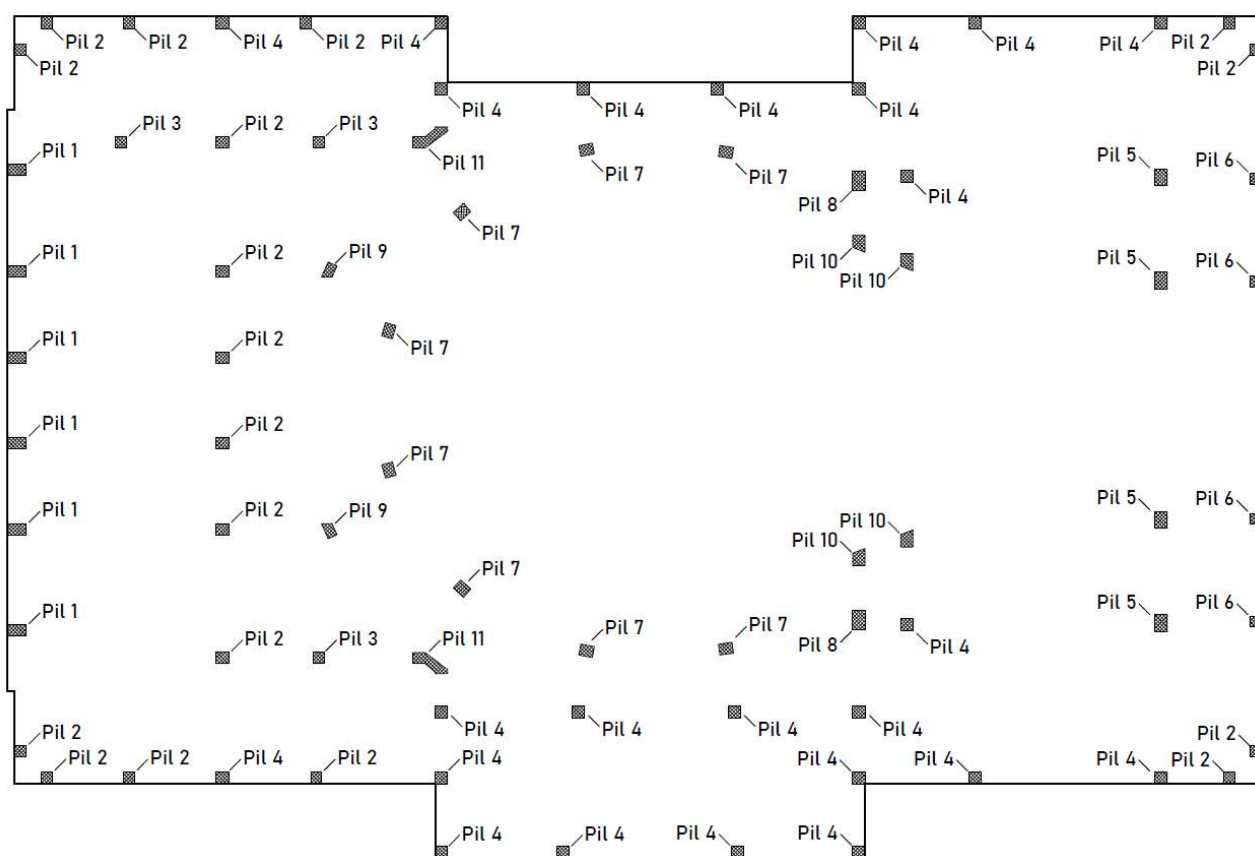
Pianta pilastri piano platea e piano 1 galleria
